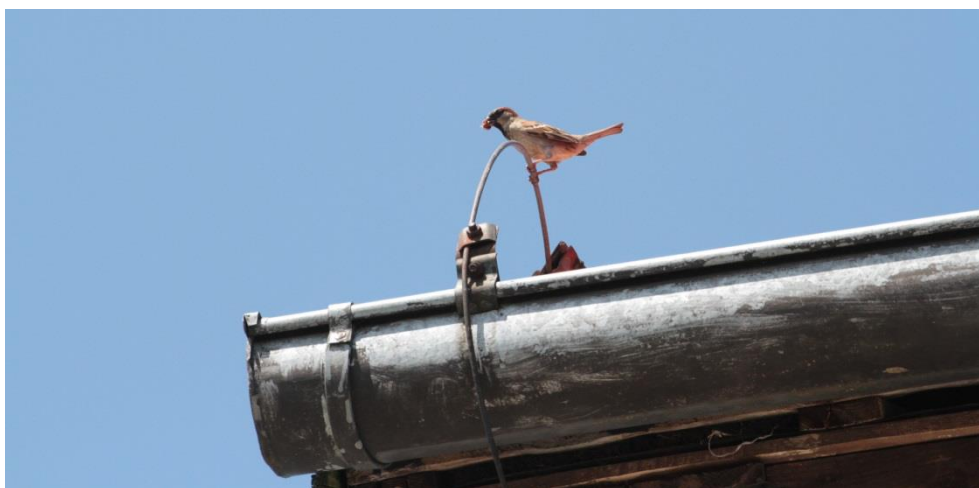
Materiał gniazdowy w elementach konstrukcji dachu (szczelina wentylacyjna) (fot. L.K.).
